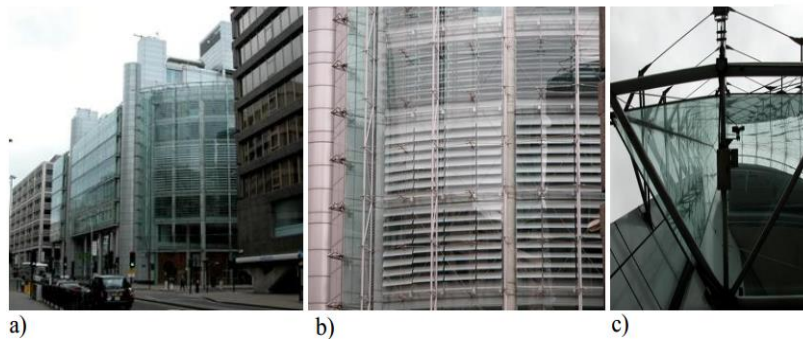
Le HeliconFinsbury Pavement; a Londres, architecte SheppardRobson: a) Vue du pavillon HeliconFinsbury; B) Dispositifs d'ombrage situés dans la cavité; C) vue à travers la cavité). (Source : Poirazis, 2004)
